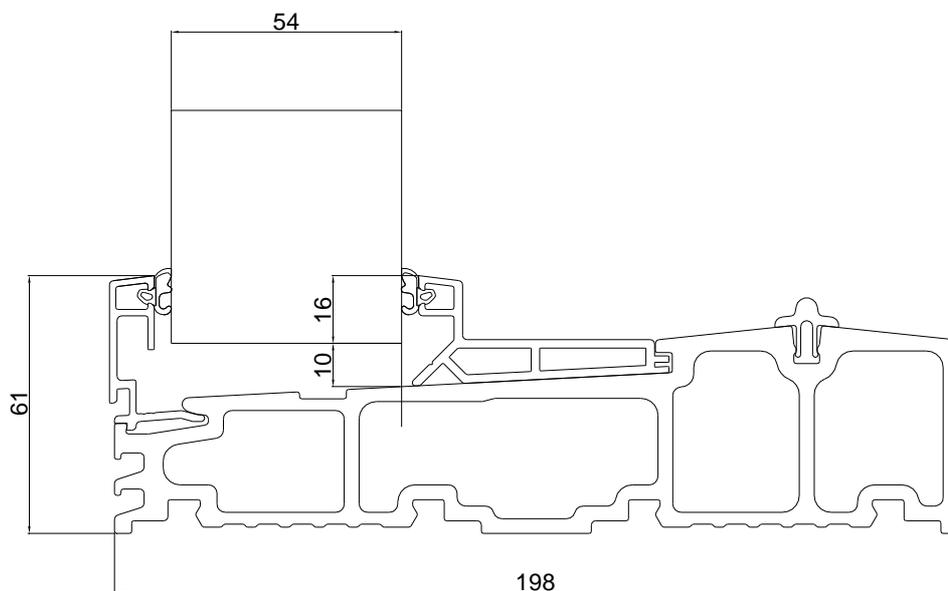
Profilquerschnitt PK05, Schwelle Standelement
